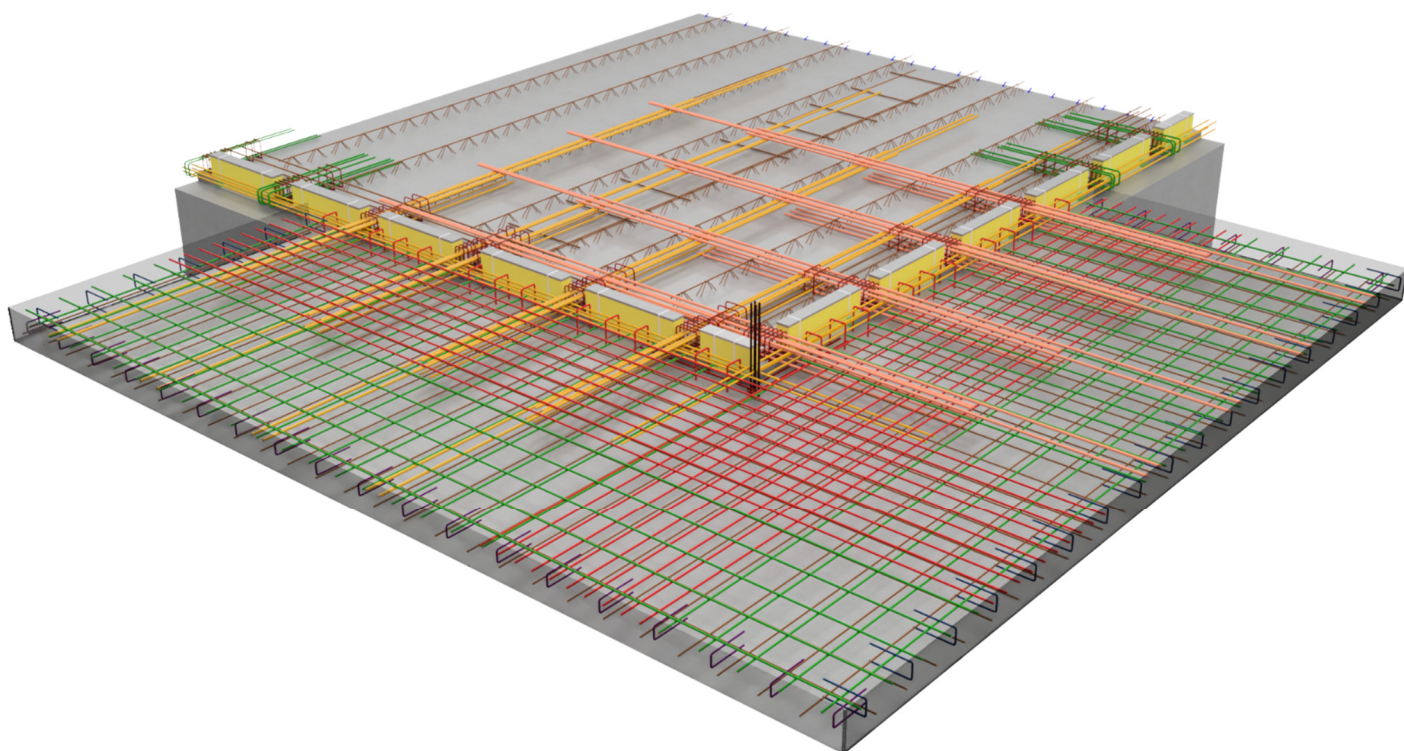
Perspective du principe de ferrailage d'un balcon d'angle
